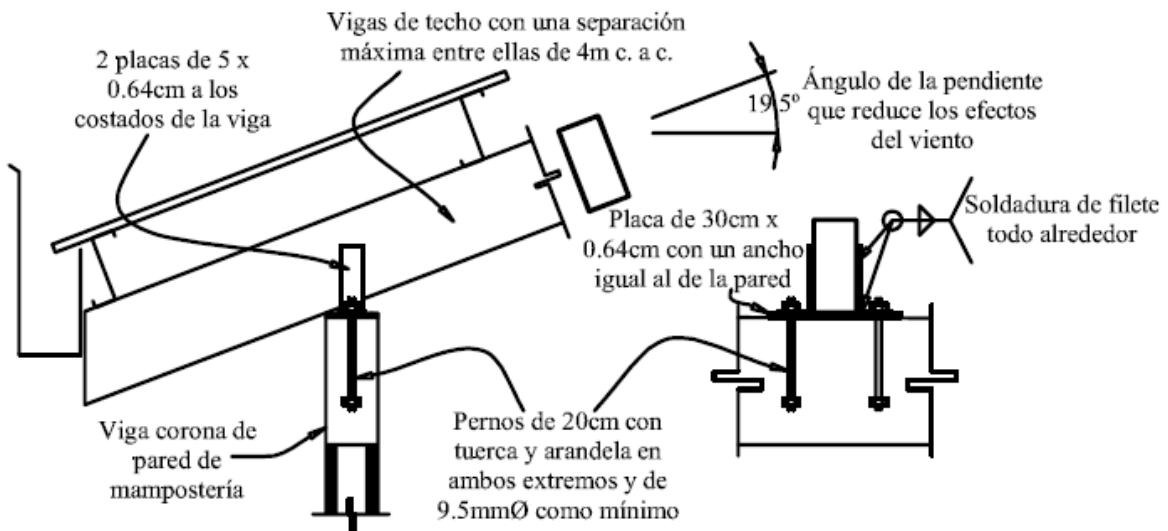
Detalle de apoyo de viga de techo en pared prefabricada de baldosas horizontales
